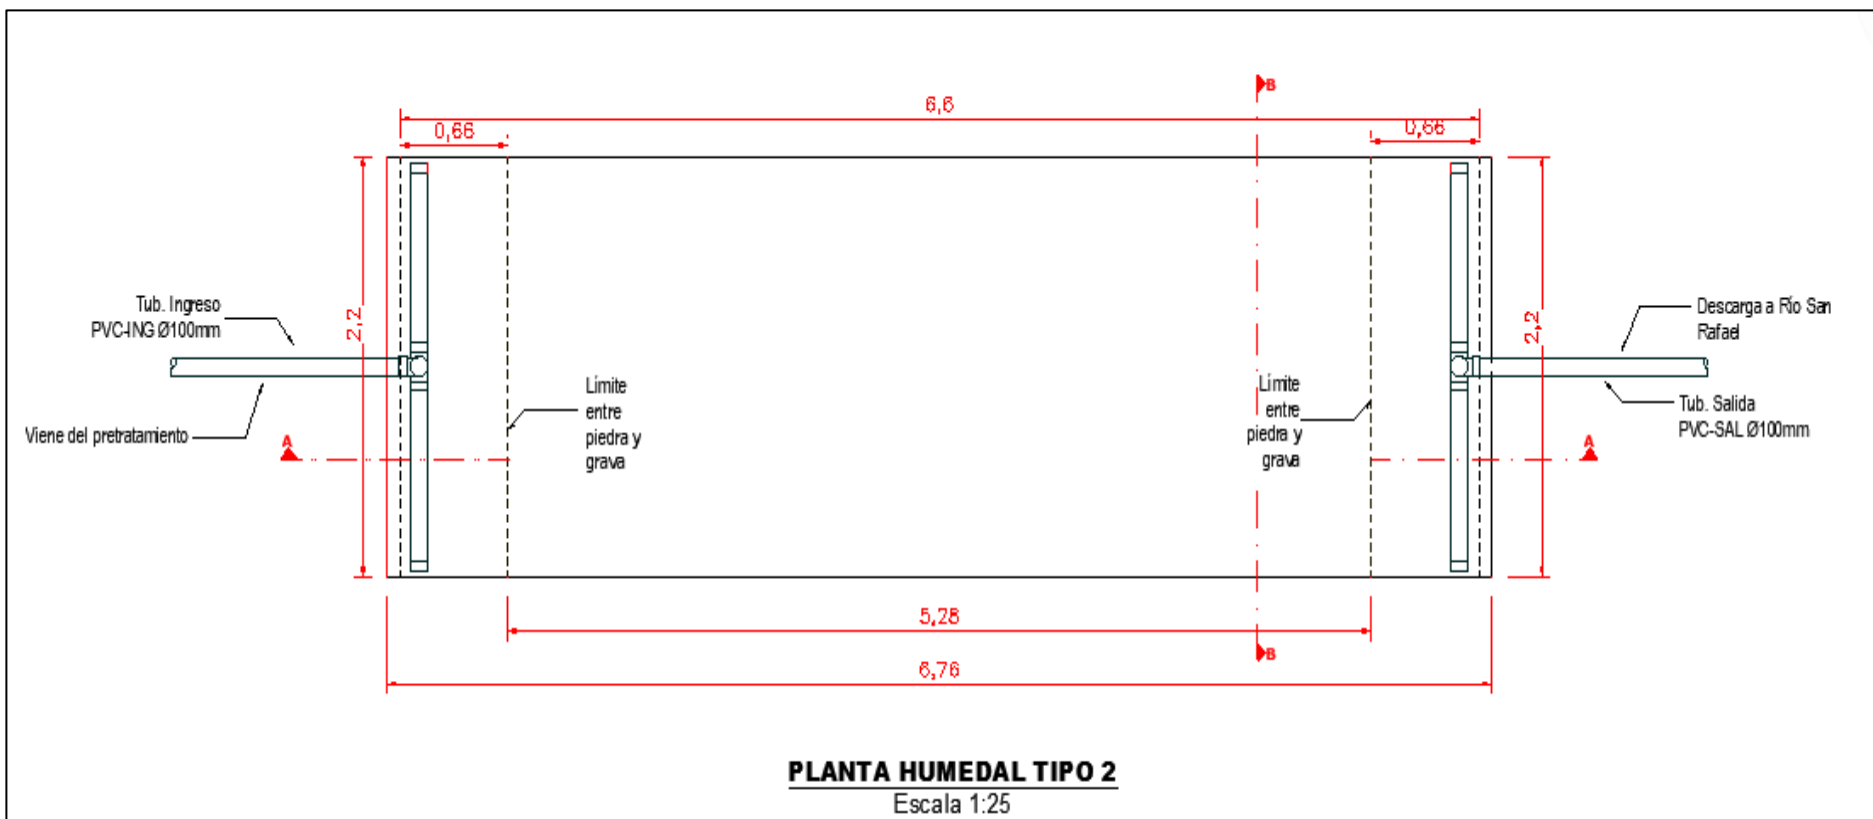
Vista en planta y dimensiones del diseño de la biojardinera
